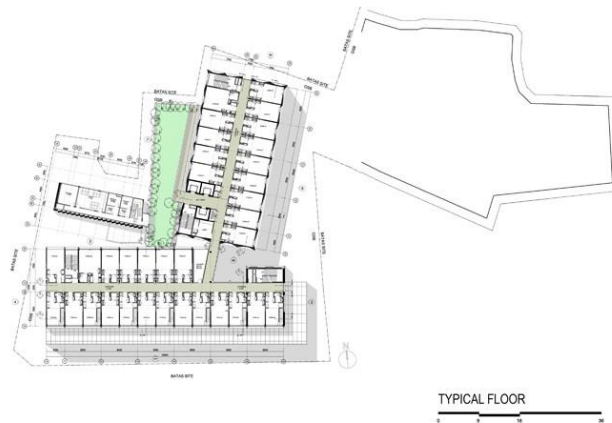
4 Denah Lantai 1 Hotel Morrissey Jakarta
